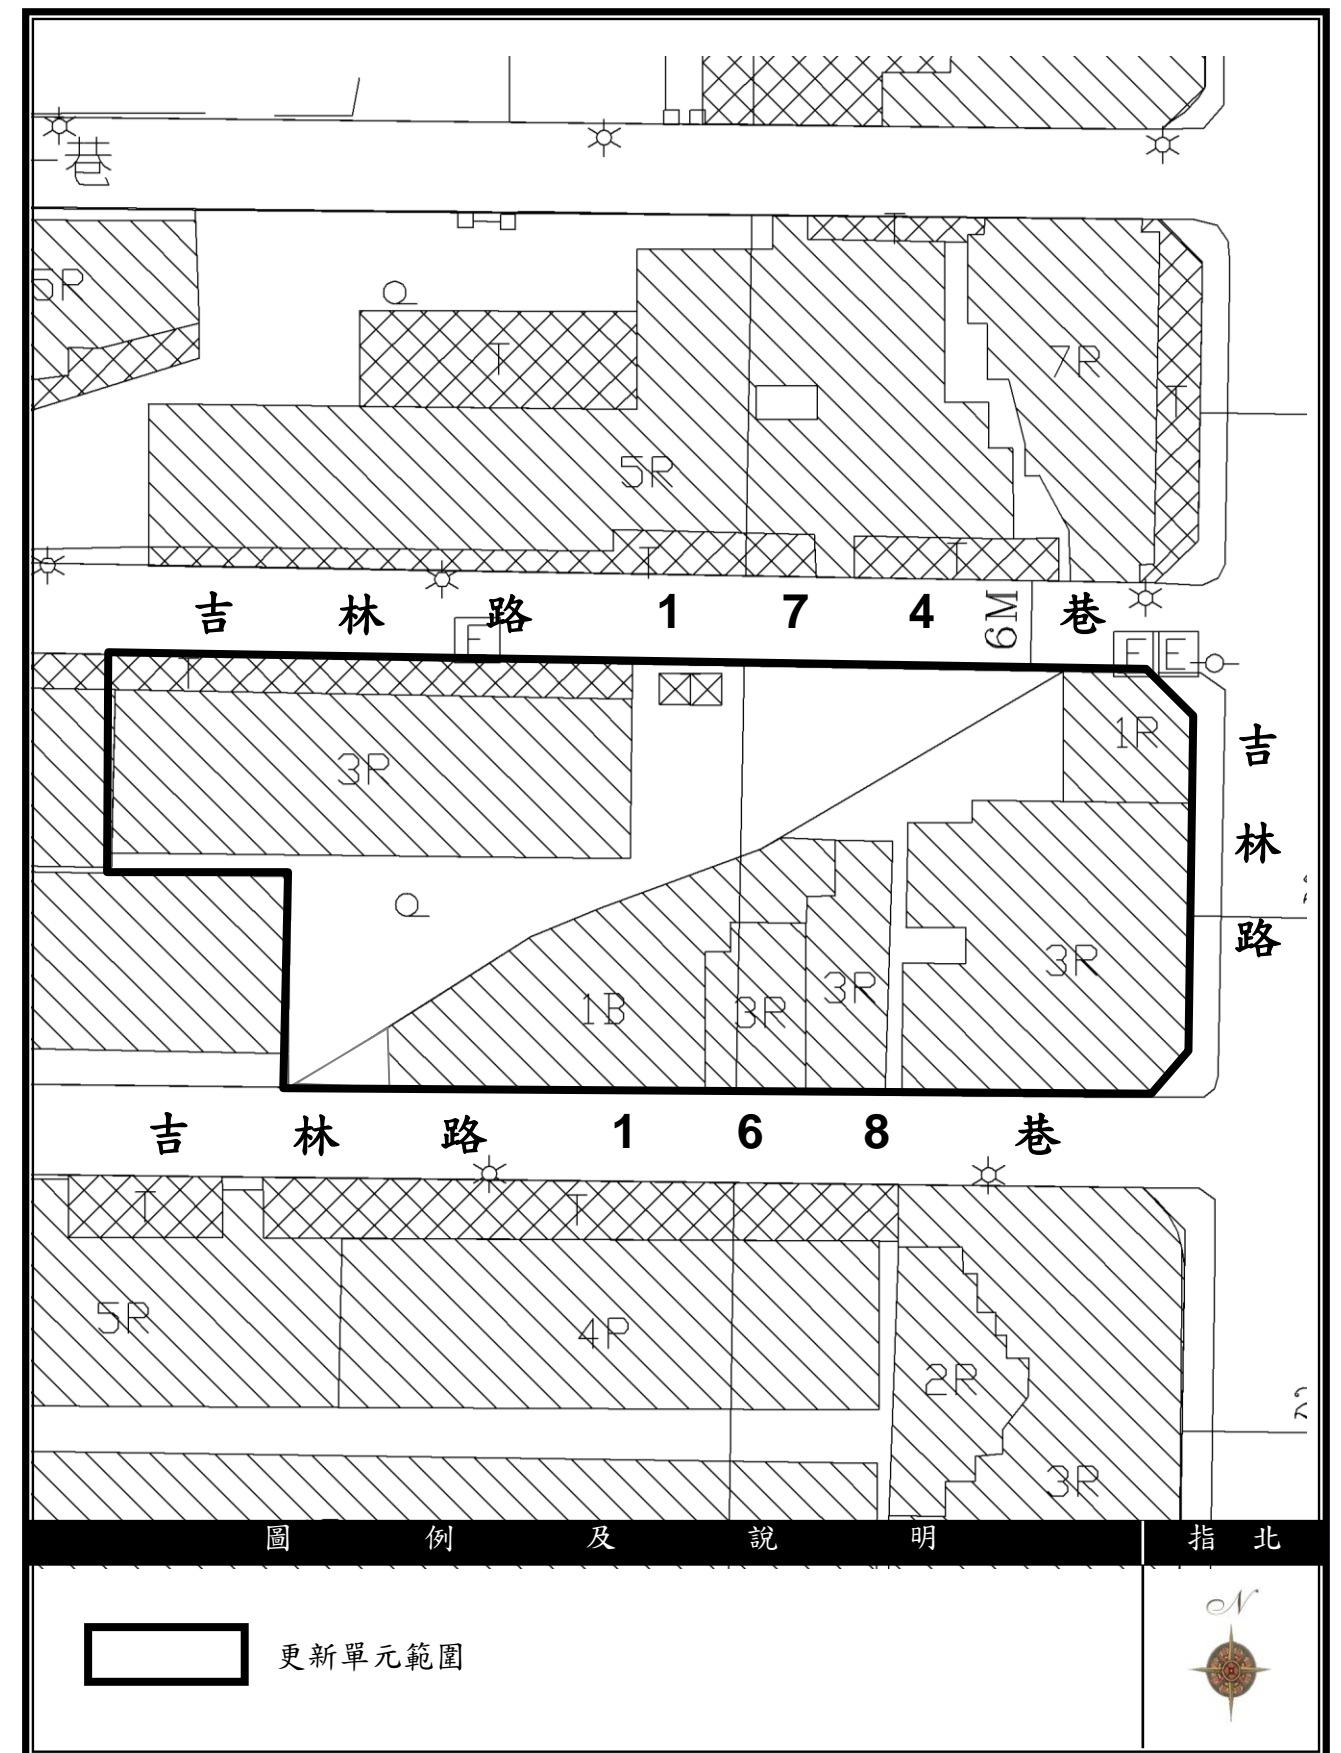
更新單元地形套繪圖(scale: 1/500)
